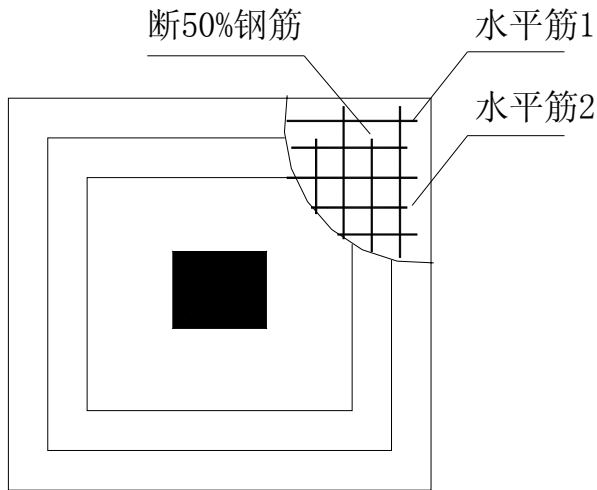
独立柱基础钢筋绑扎示意图 2
